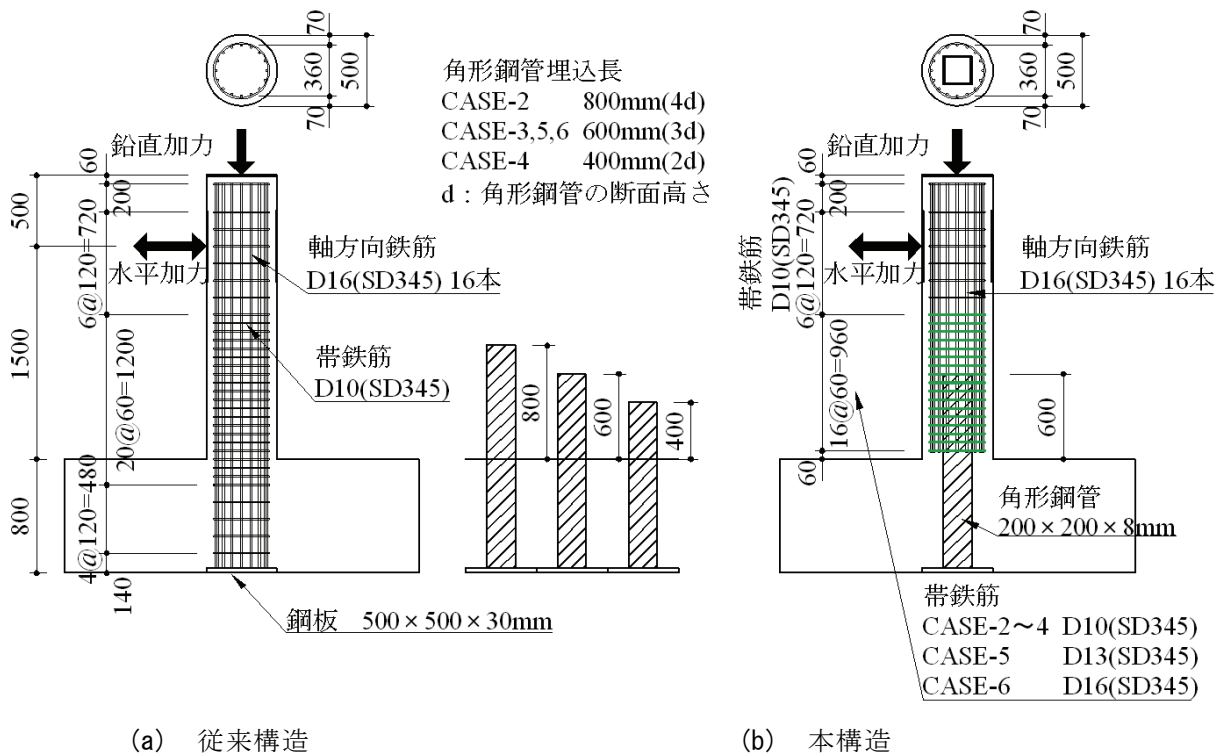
試験体配筋図および鋼管埋込長 (単位 mm)
